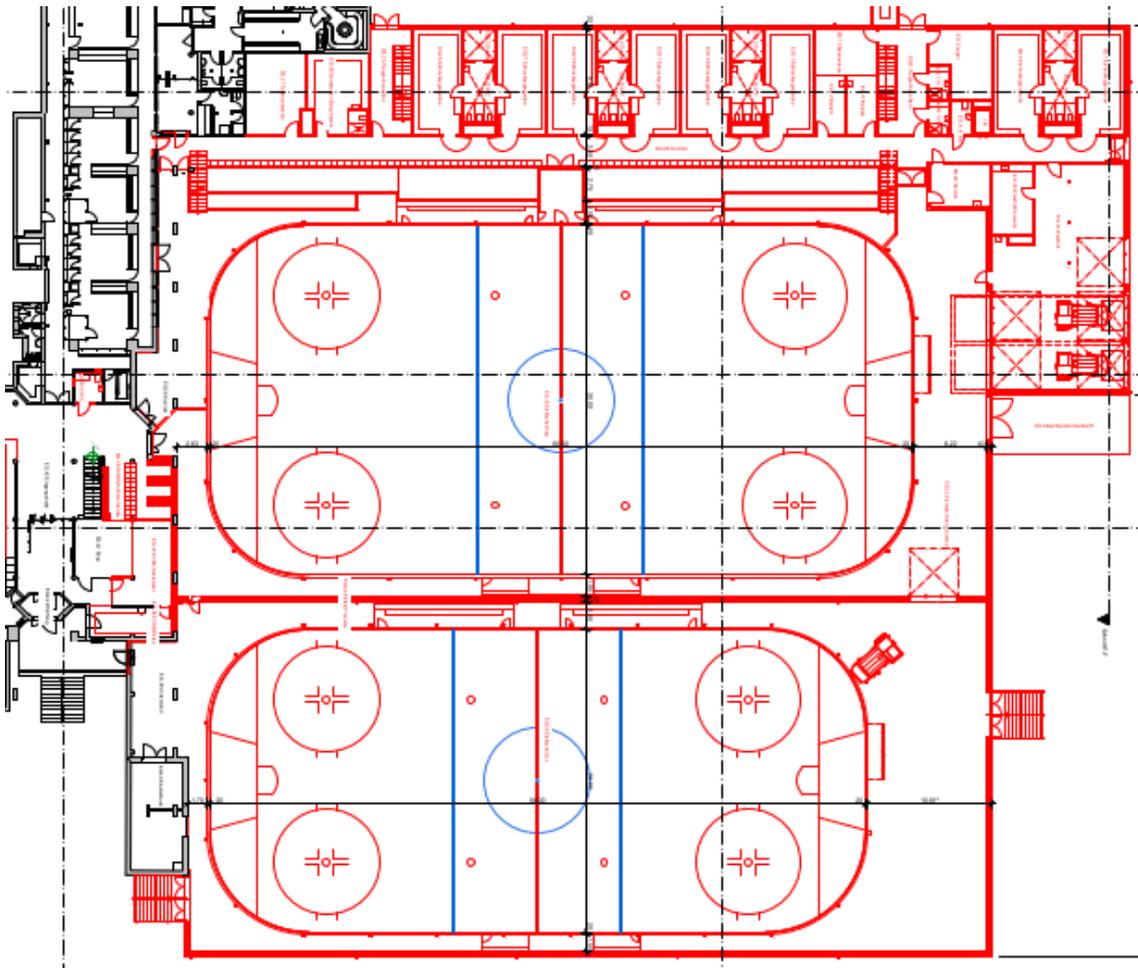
Grundriss Erdgeschoss, Eishalle und Garderoben
